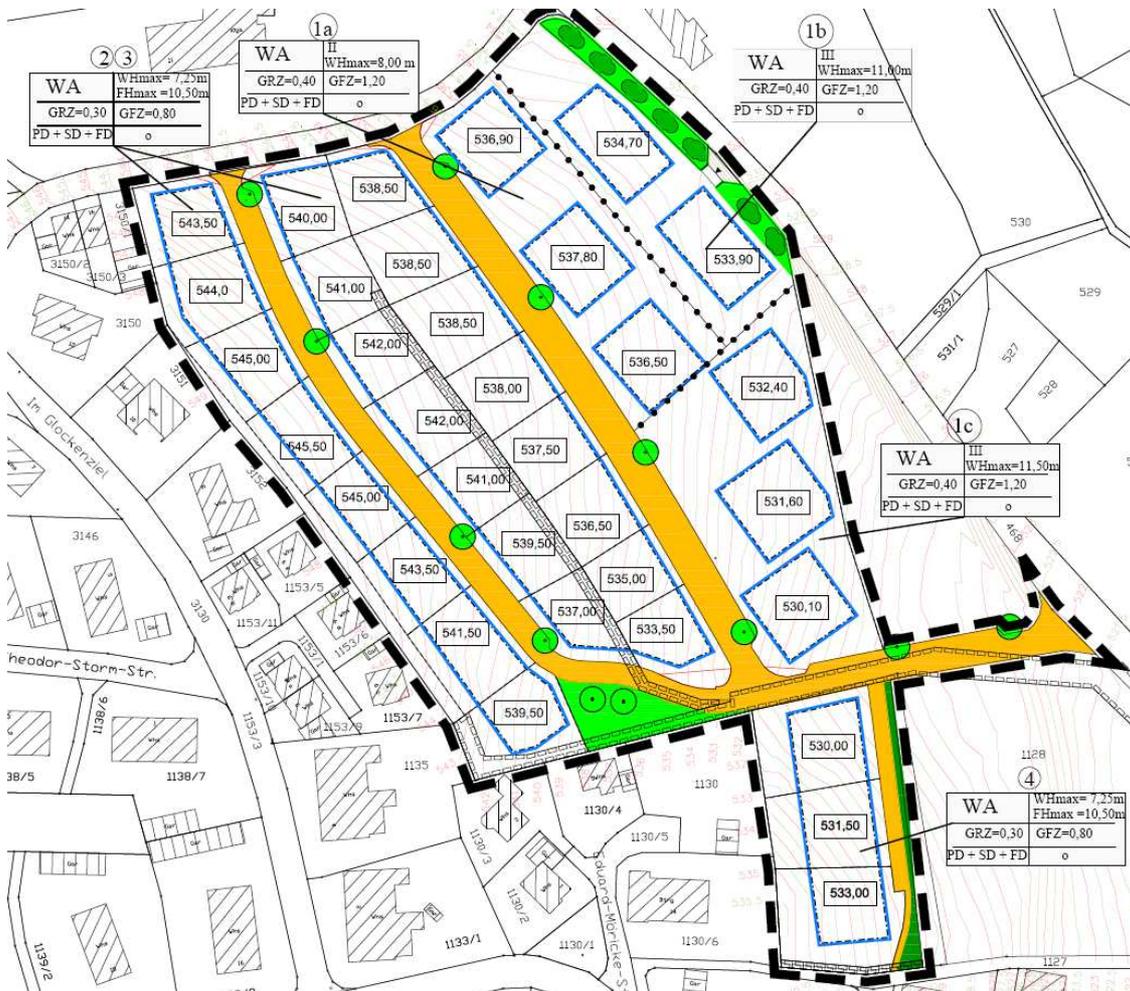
Rechtsplan zum Bebauungsplan „Glockenziel III, 1. Änderung“ vom 26.10.2017
